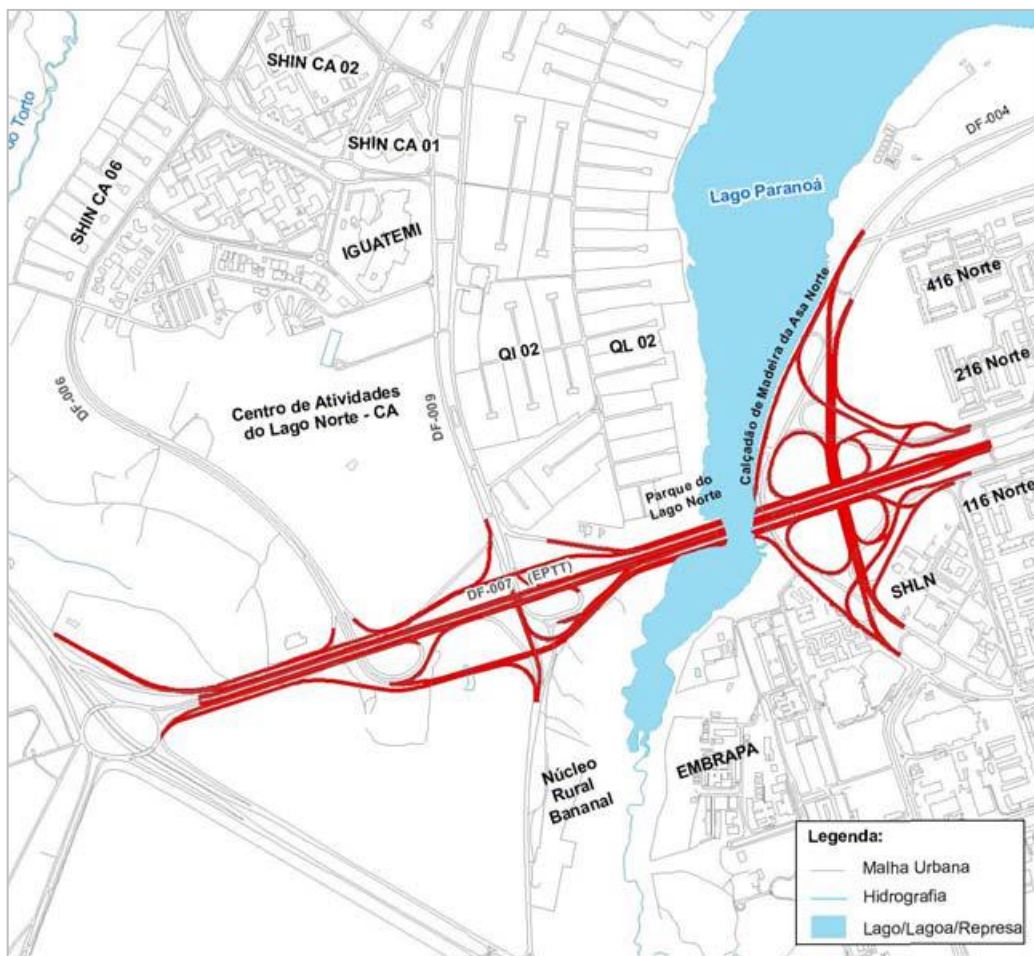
Traçado proposto para duplicação do TTN (Fonte: DER-DF, 2013).
